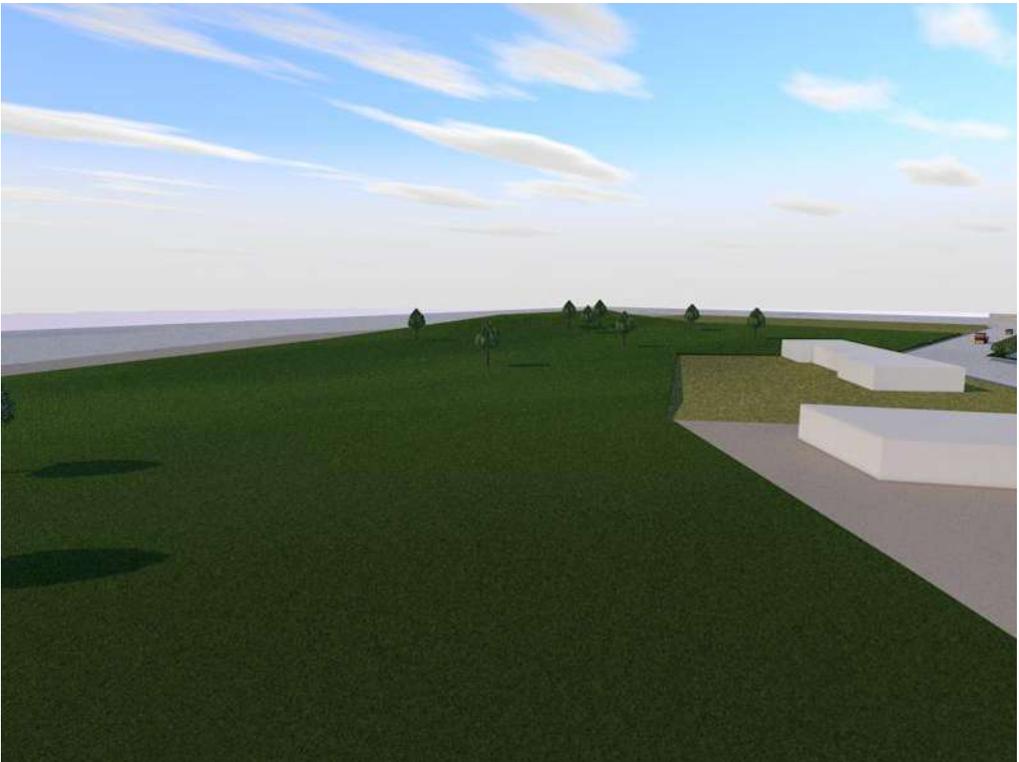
Vista Sur del terreno. Autor: Cynthia Alvarado
